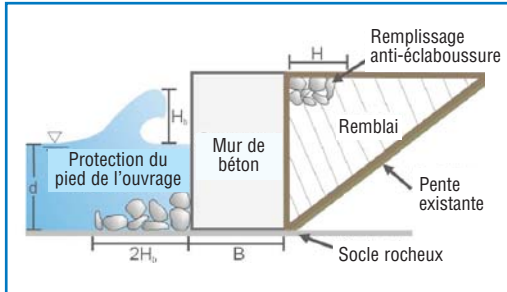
Schéma conceptuel d'un ouvrage de protection des rives
